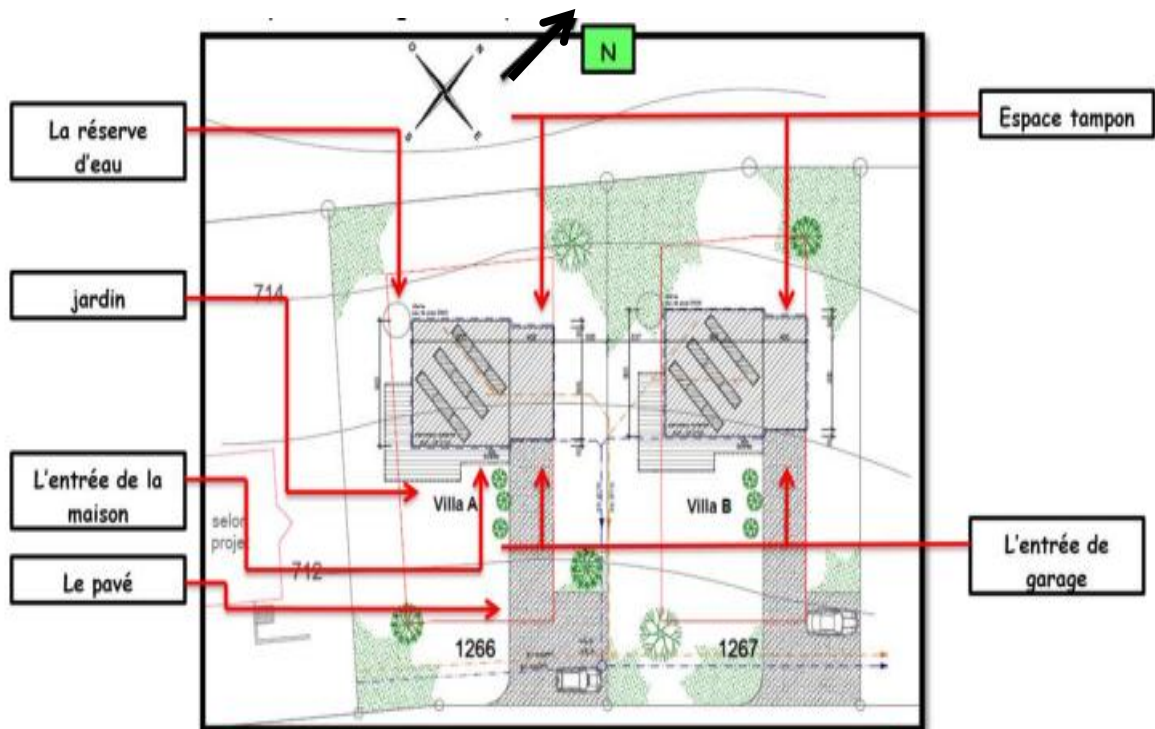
Plan de Masse .Source : <http://lab-immo.ch/1037-/mangerie-P-ECO MAISON>
